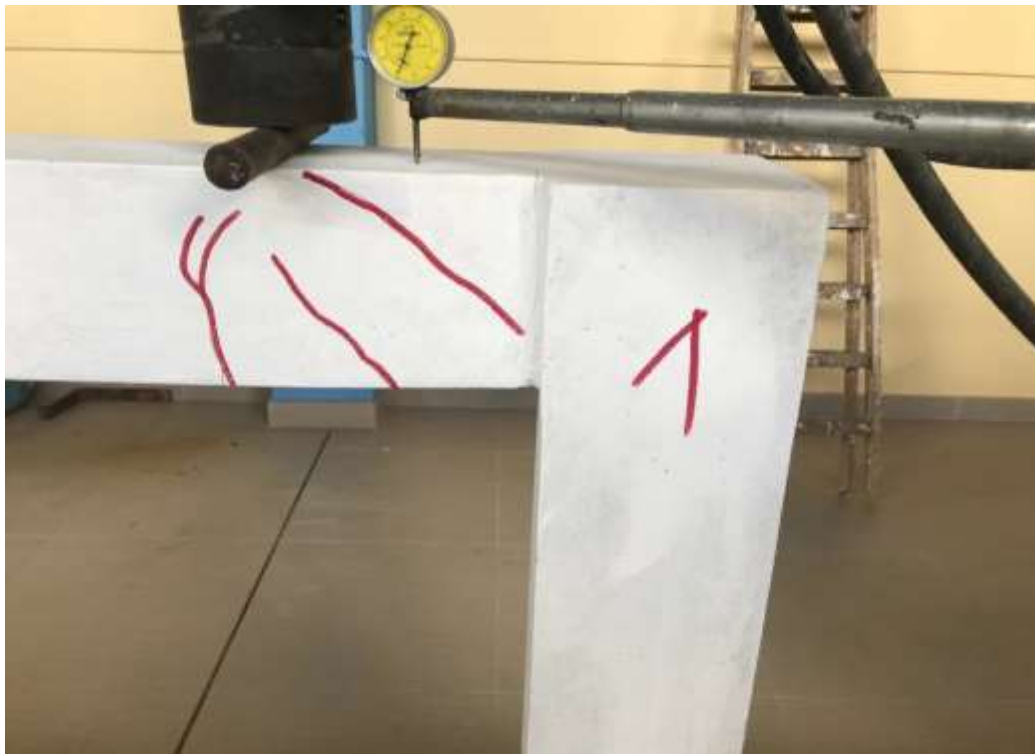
Falla producida por esfuerzo cortante en la viga de concreto armado con el primer estribo espaciado a 2.5 cm medido a partir de la cara de la columna.
